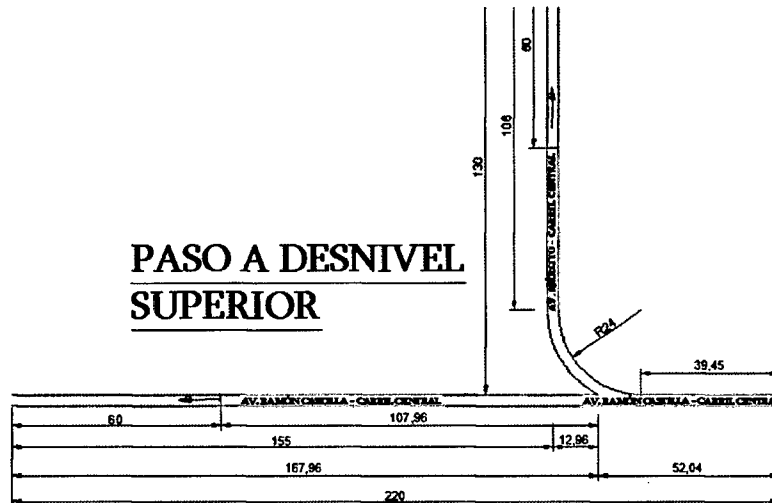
Planteamiento en planta del paso a desnivel superior.
